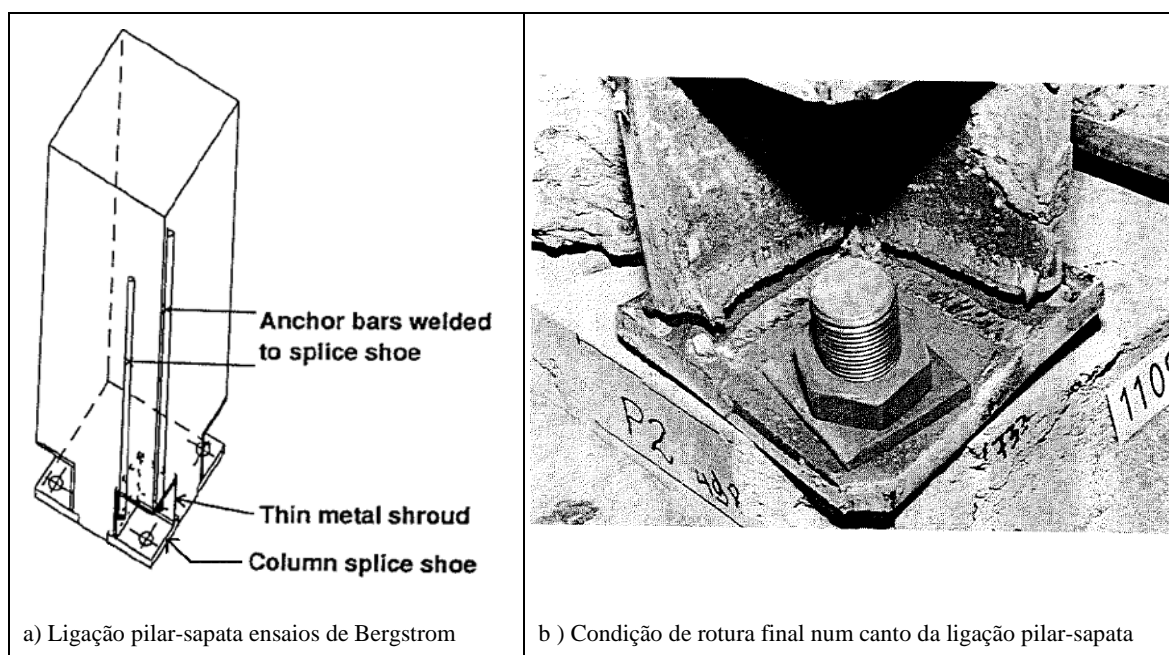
Ligação pilar-sapata – Detalhes (Elliott, 1996)
